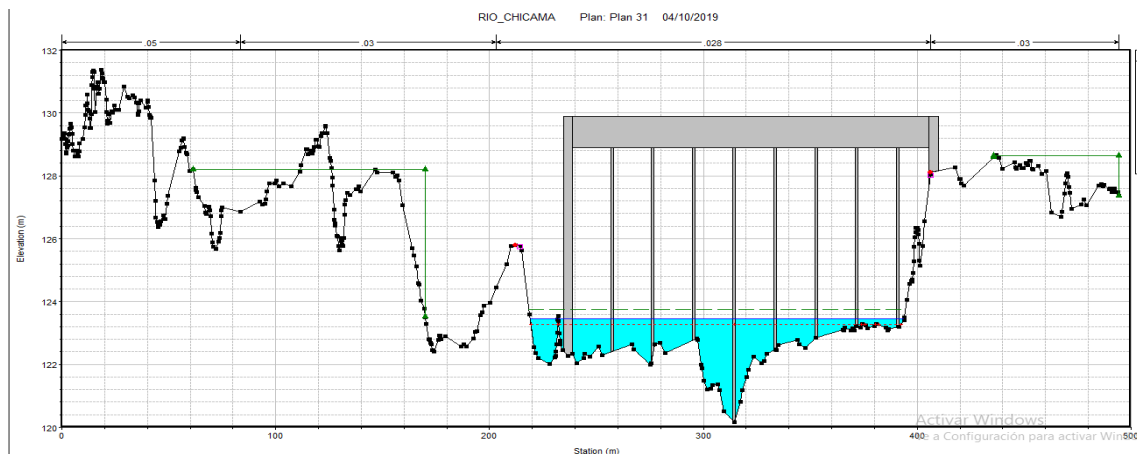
Sección puente viejo en PF3 con un tirante de 2.84m.
